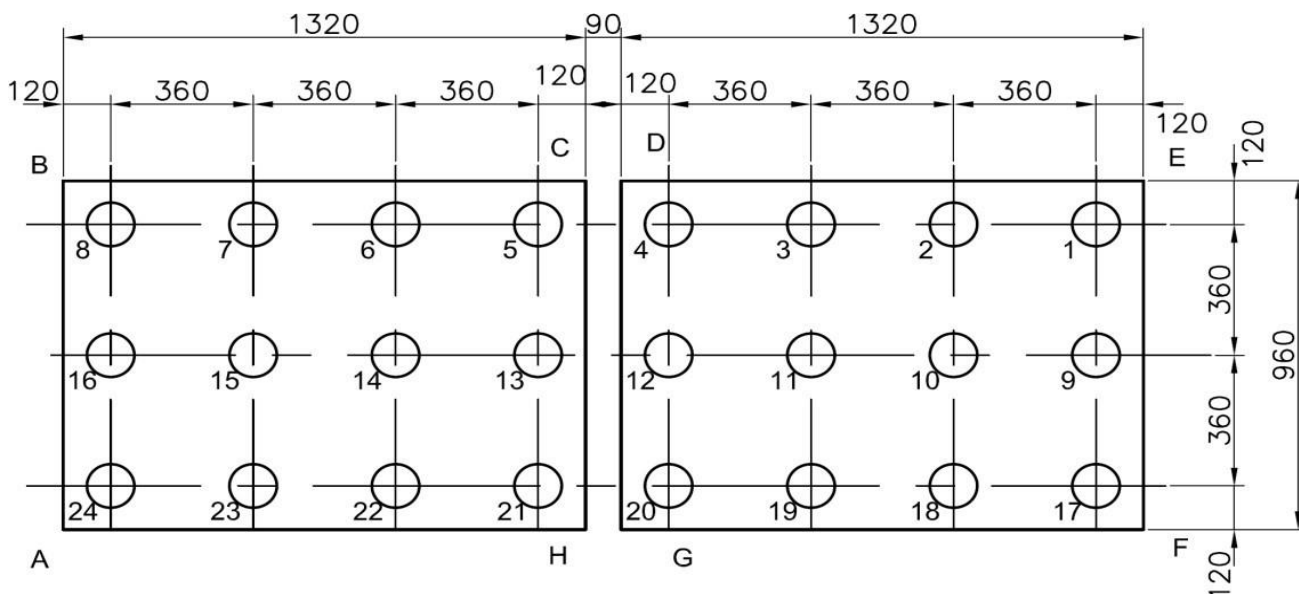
Plan de disposition des pieux sous les deux semelles
